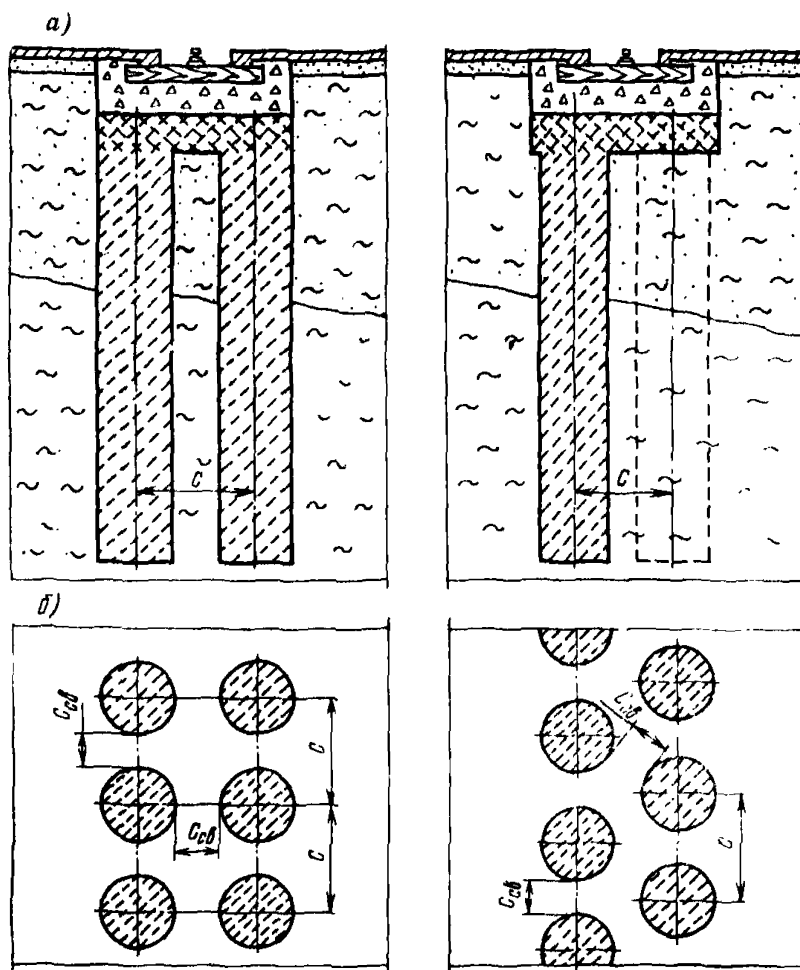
Схемы подкрановых путей на илцементных сваях (слева — без относительного смещения свай в рядах, справа — с относительным смещением свай в рядах): а — поперечный разрез; б — план
